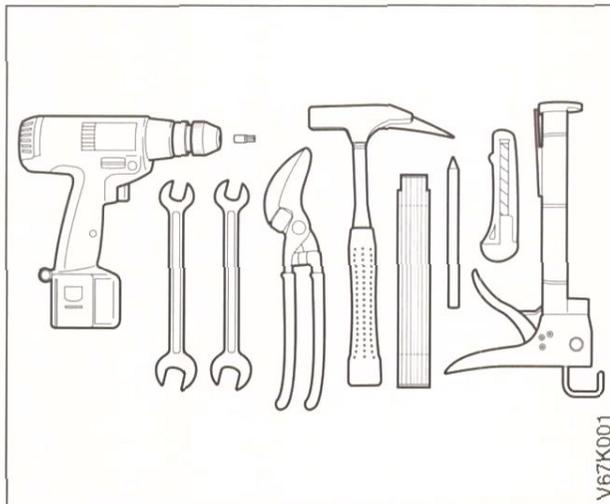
Montage-Werkzeuge: Bohrmaschine, Kreuzschlitz-Bit PZ2, 2 Maulschlüssel Nummer 19 und 23, Blechschere, Hammer, Zollstock, Bleistift, Teppichmesser, Silikonspritze (ggf. Flex mit Steinscheibe).
